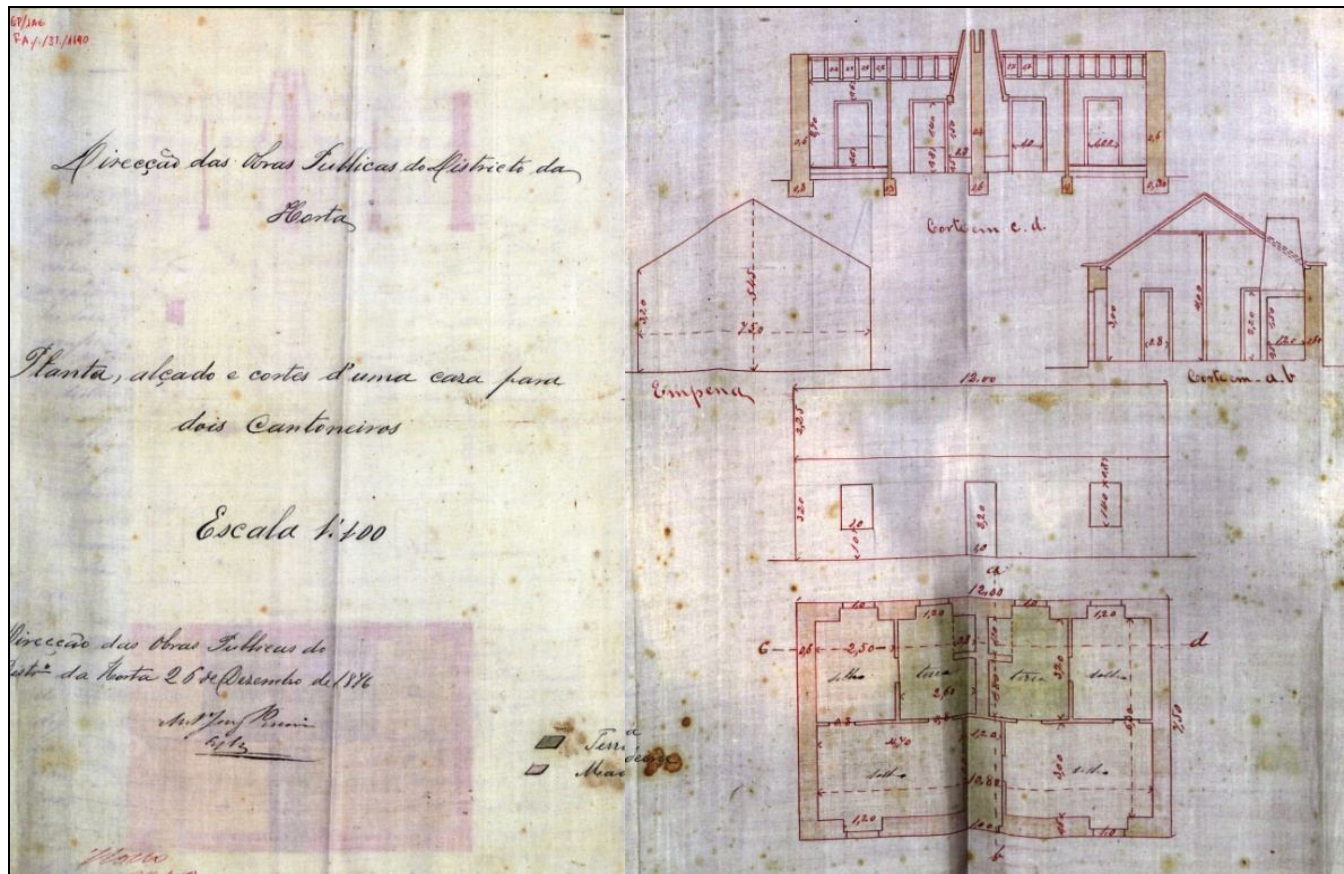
António Joaquim Pereira, *Planta, alçado e cortes d'uma casa para dois Cantoneiros*. 1876
